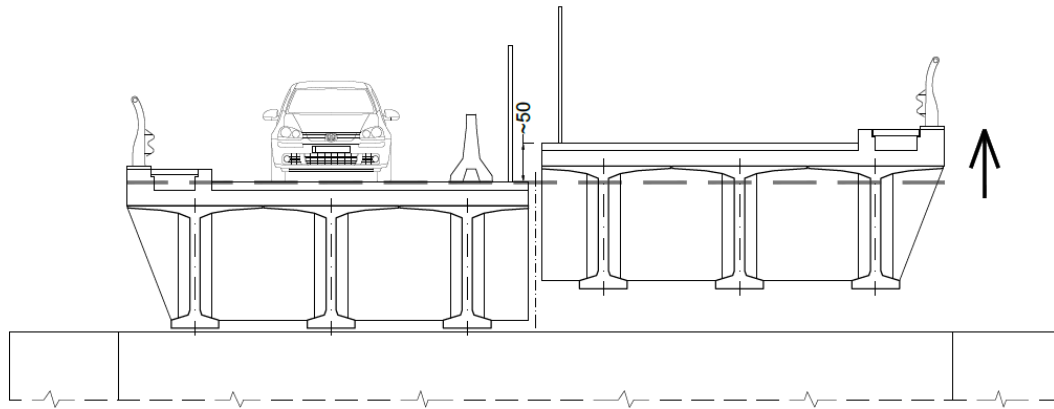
Fase di sollevamento dell'impalcato con mantenimento della viabilità
